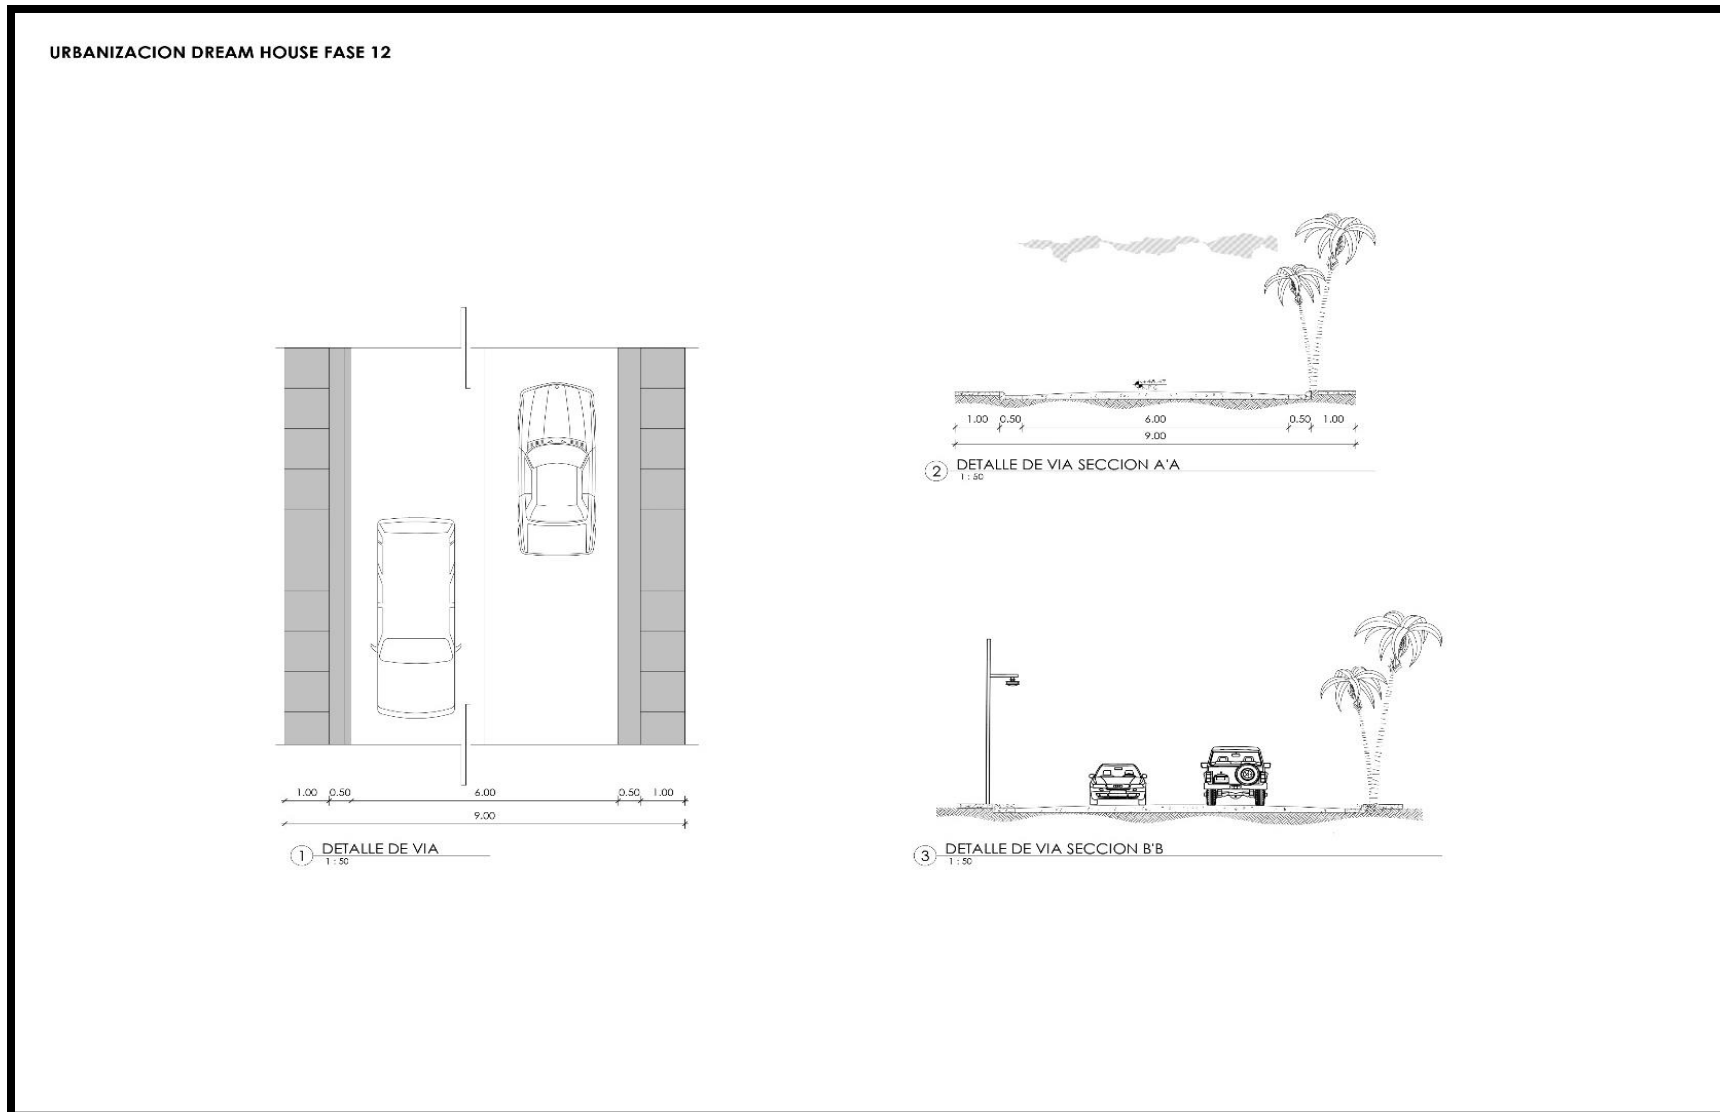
Plano de detalle de las vías internas del proyecto.
